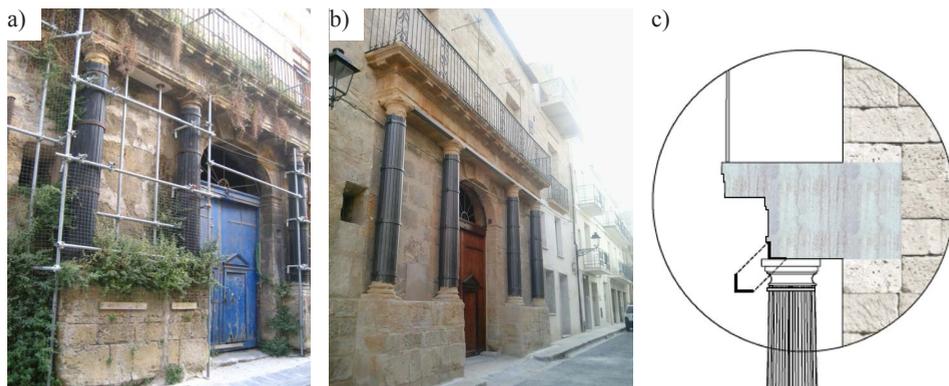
Palazzo Pavone, Castelvetro: a) ingresso al palazzo nello stato di fatto; b) ingresso al palazzo a recupero strutturale ultimato; c) particolare rinforzo cornicione con profilato ad L.
